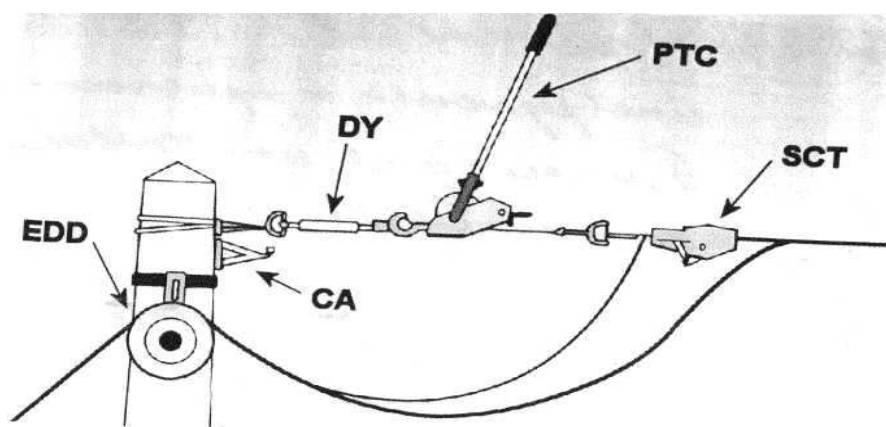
Применение инструмента и приспособлений для натяжения линий СИП
